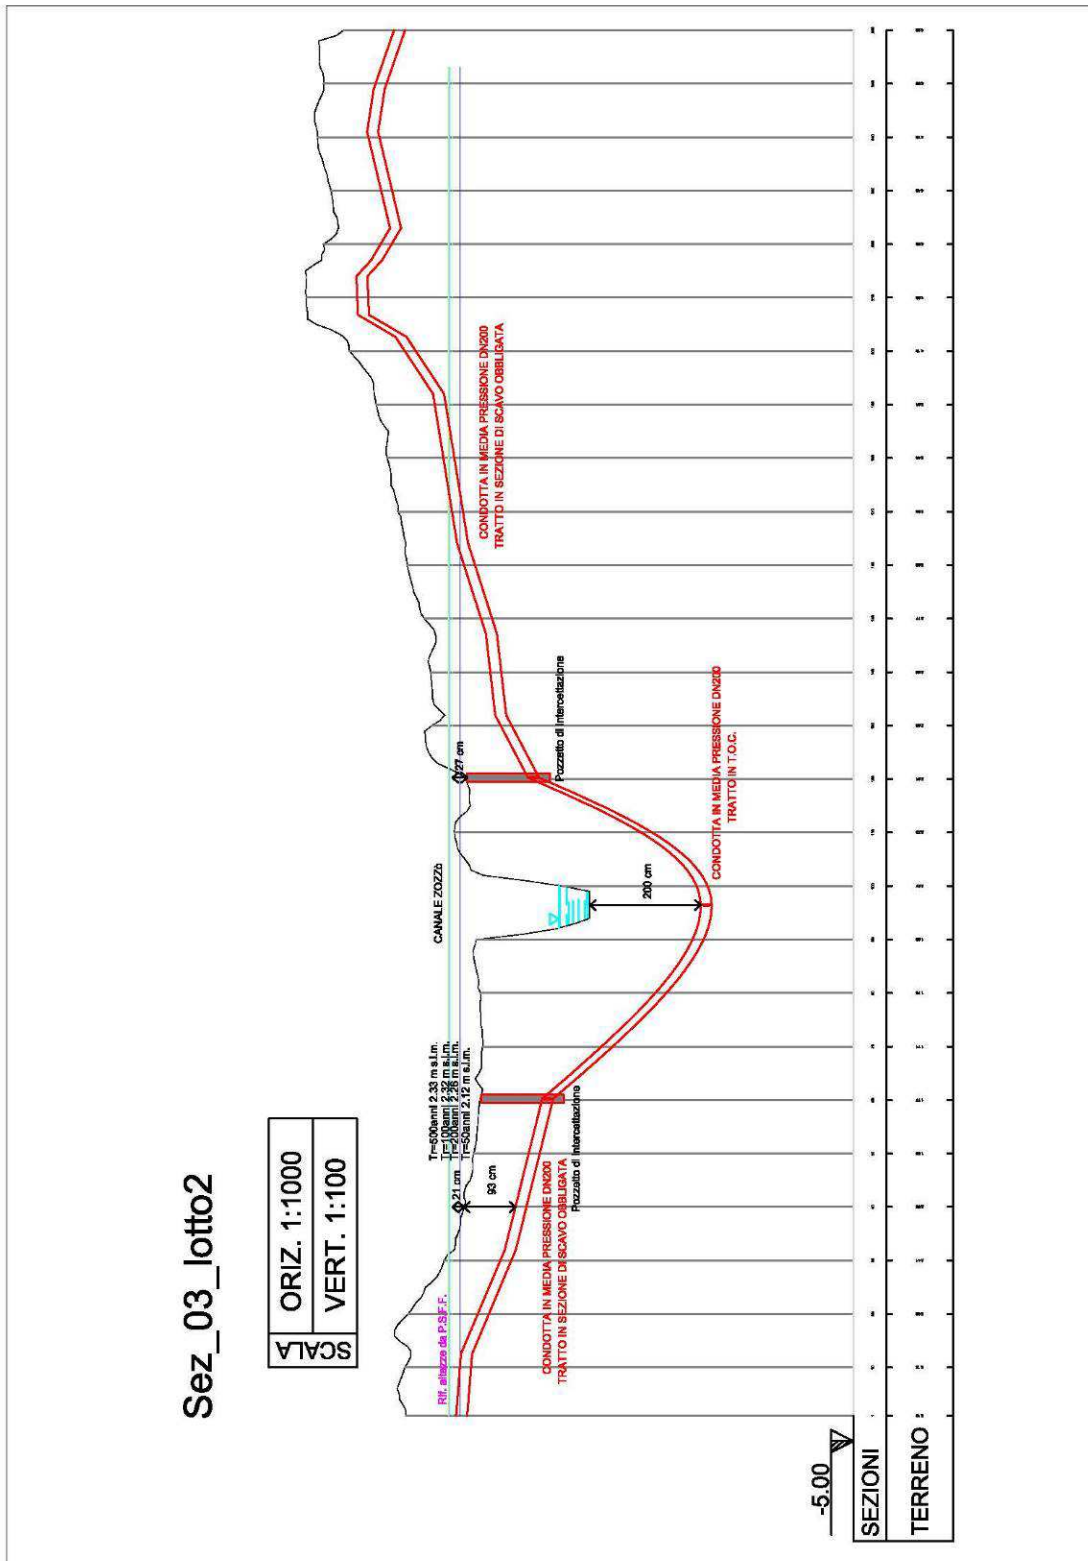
Sezione "Sez_03_lotto2". Stralcio della sezione dell'attraversamento del Canale Sozzo.
